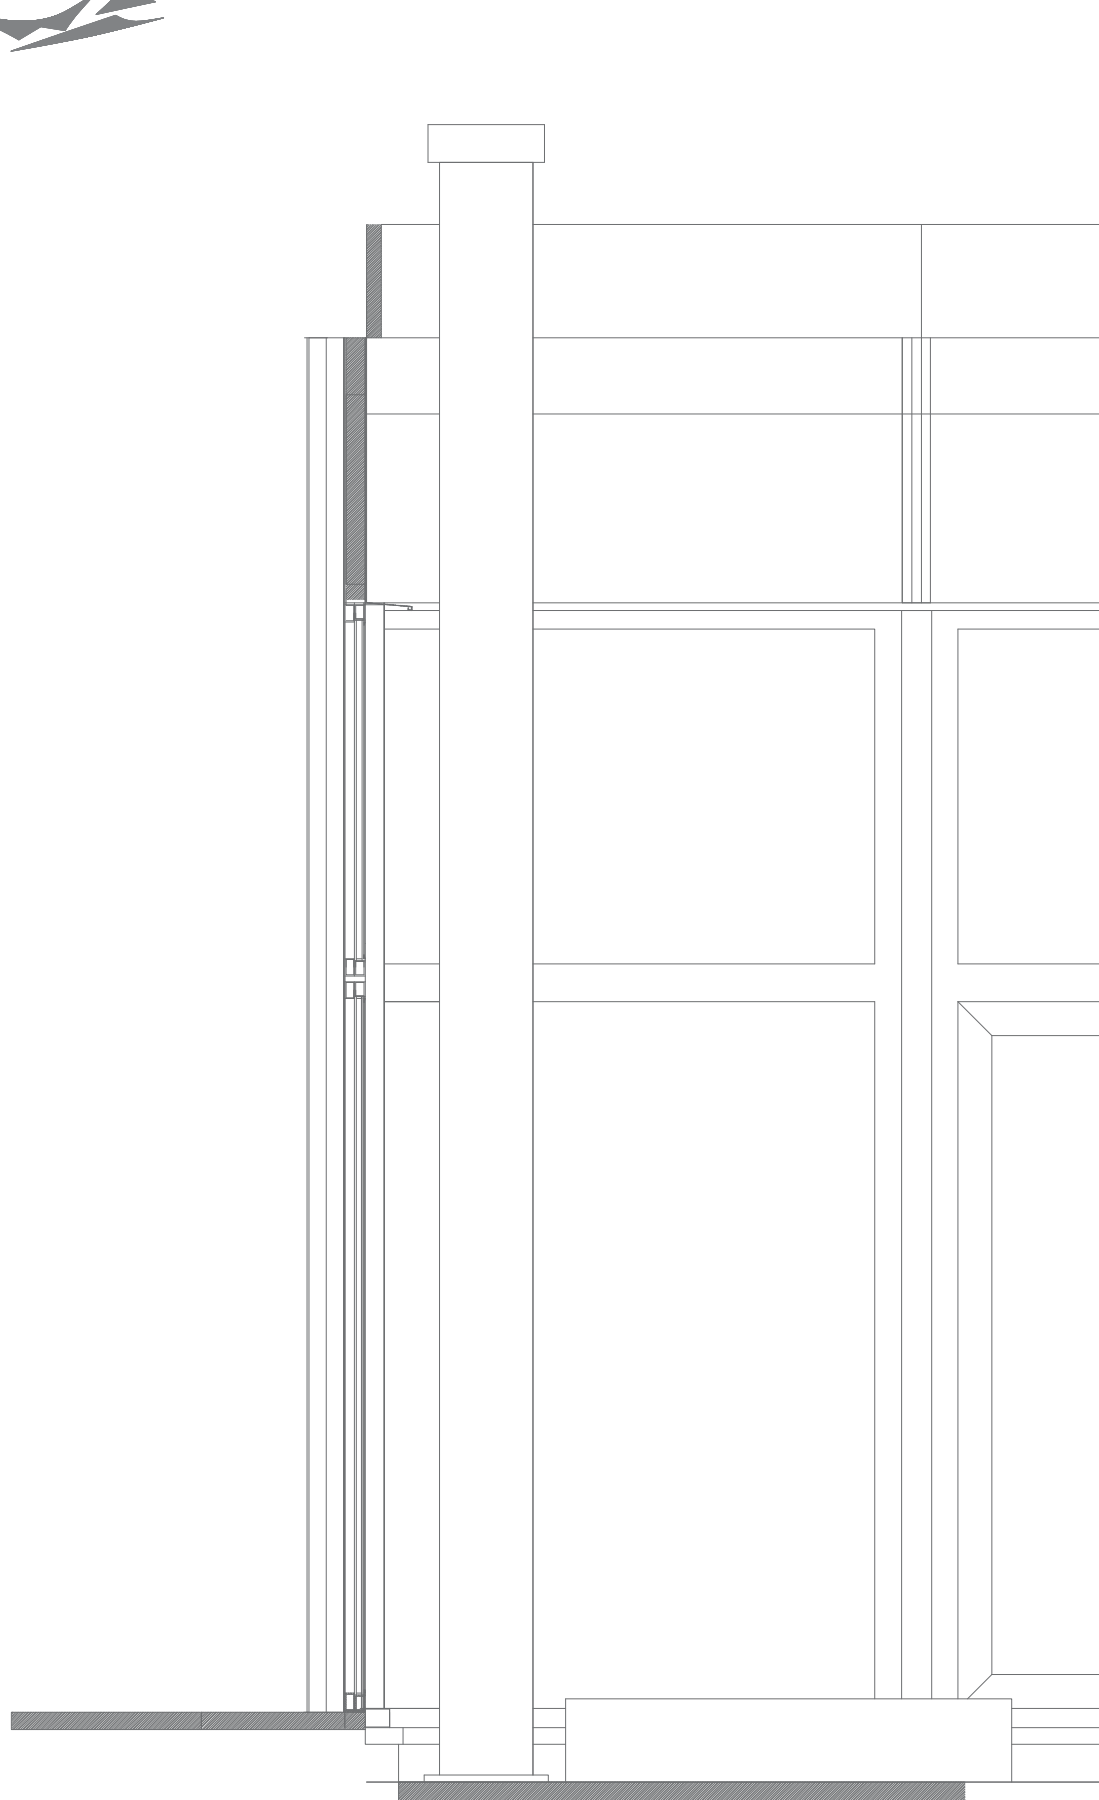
Carpintería del patio interior de la ETSIE.
